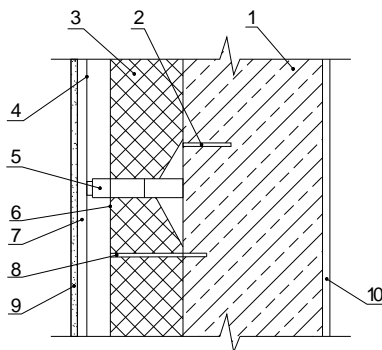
Система навесного фасада 1 – газосиликатные блоки;
